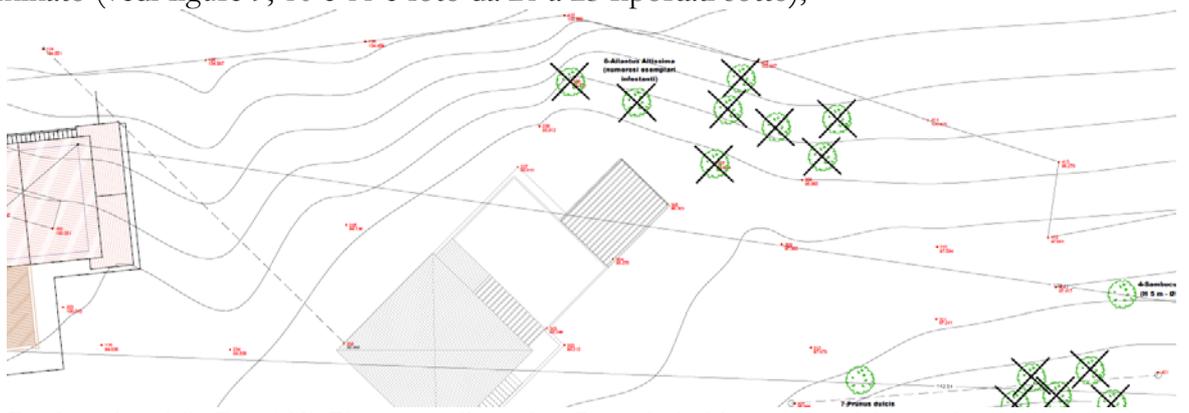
stralcio della Tav. A02b Planimetria Generale – Piano degli abbattimenti - del settembre 2016.
